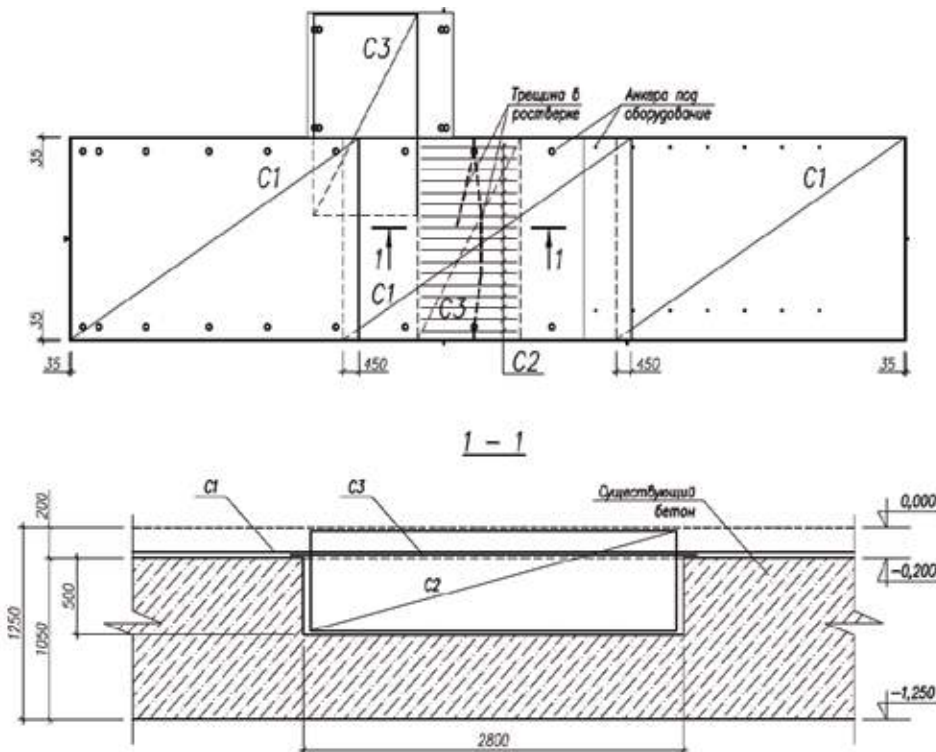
Схема усиления фундамента путем поперечного штрабления, армирования и замоноличивания трещины по проектному решению специалистов СПбГАСУ
